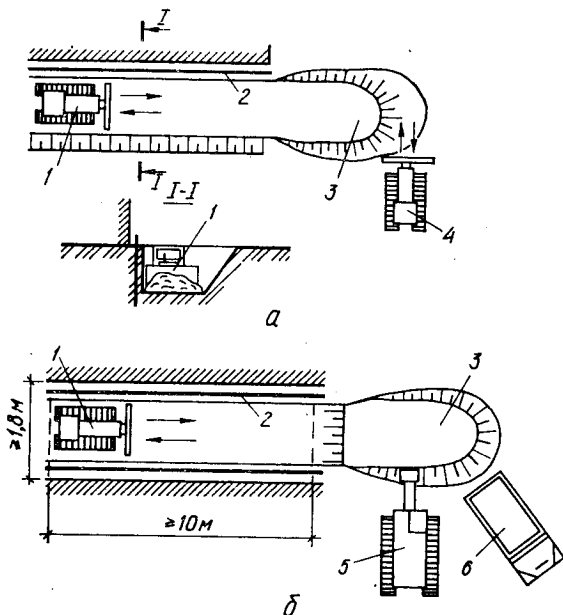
Разработка грунта бульдозером в стесненных условиях:
